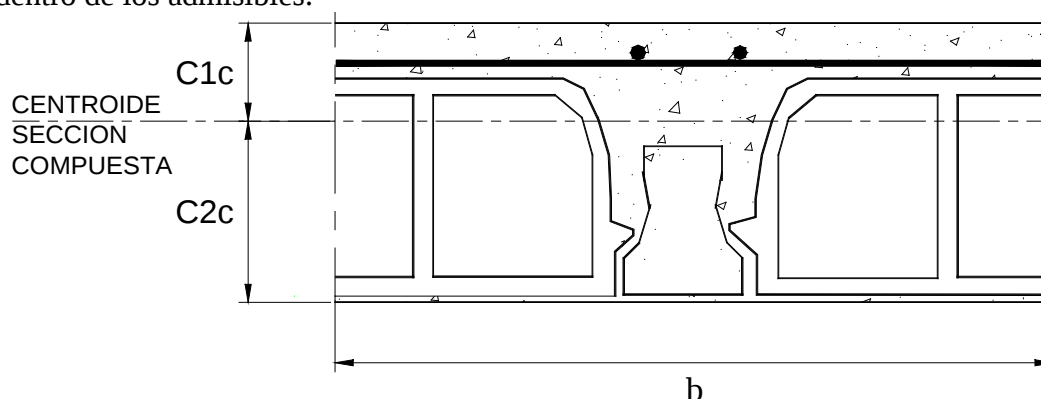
Sección de una losa compuesta con viguetas prefabricadas.
